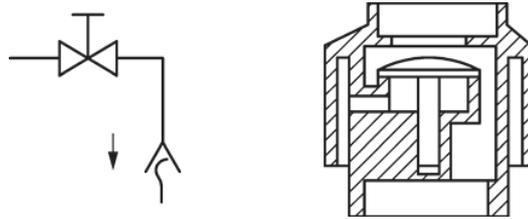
Sicherungsarmatur der Familie H, Typ B und Konstruktionsprinzip
